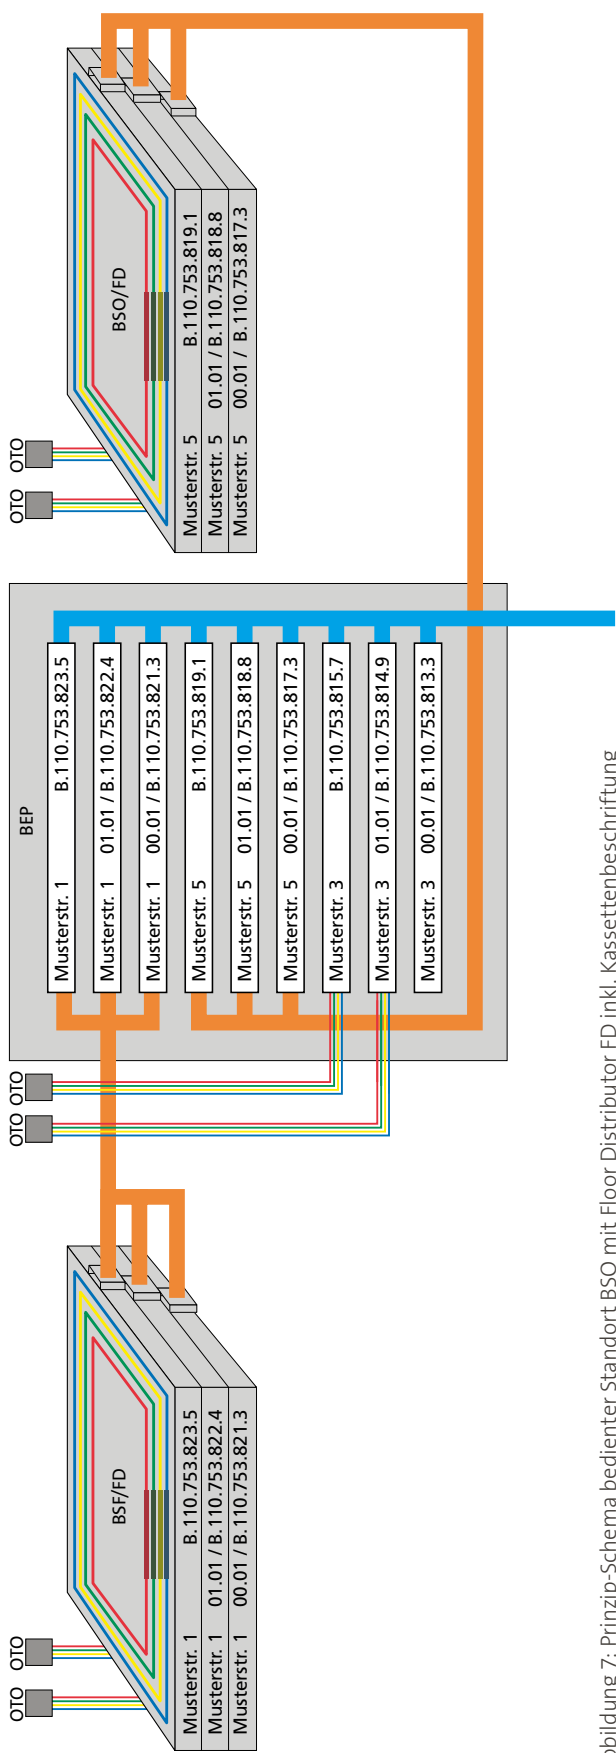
Prinzip-Schema bedienter Standort BSO mit Floor Distributor FD inkl. Kassettenbeschriftung
